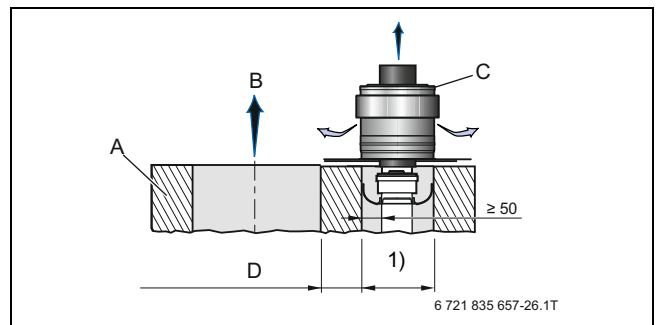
Минимальные размеры сечения вала и устья вала для трубы дымовых газов (размеры в мм)
